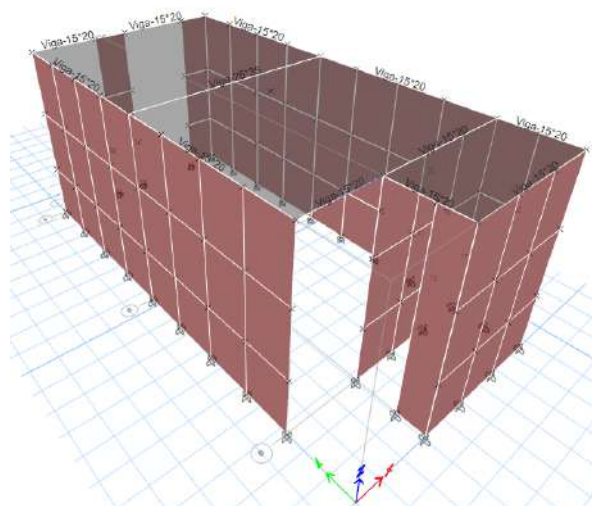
Vista en planta del modelamiento de la vivienda 08
